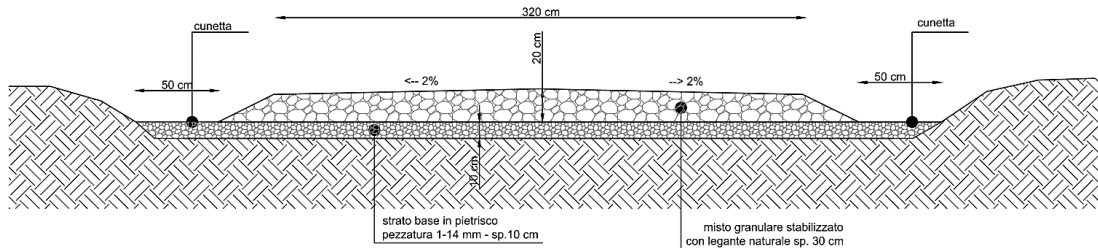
Sezione tipo strada di collegamento impianto/viabilità pubblica (Fonte: ns elaborazione)
